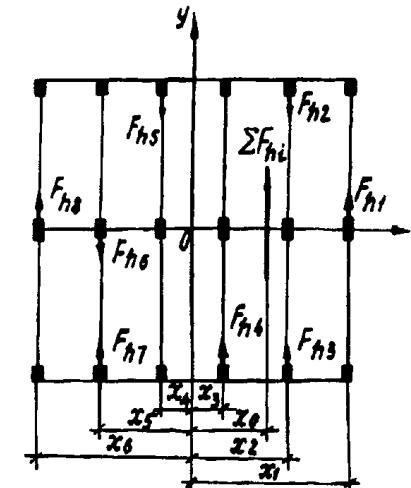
К определению дополнительных горизонтальных усилий, вызванных отклонениями колонн от вертикали
